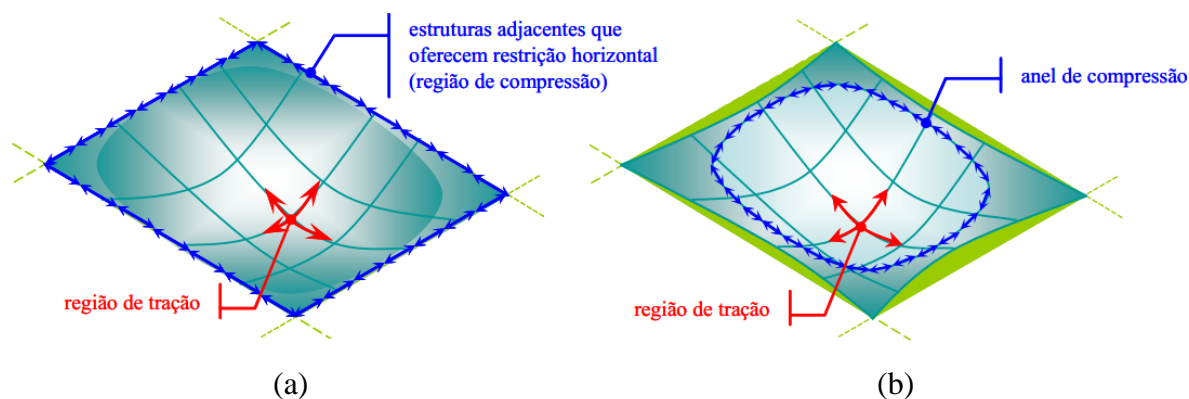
Ação de membrana de tração em lajes mistas, por Costa (2008)
